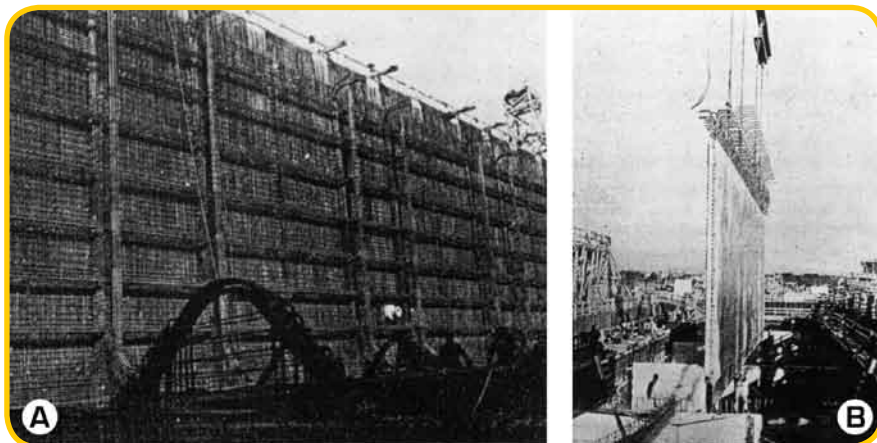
(A) Excesso de armaduras nas cascas laterais dos navios de Savannah; (B) posicionamento das armaduras prontas na execução da antepara longitudinal, projeto em Nacional City. (Tuthill, 1945)
